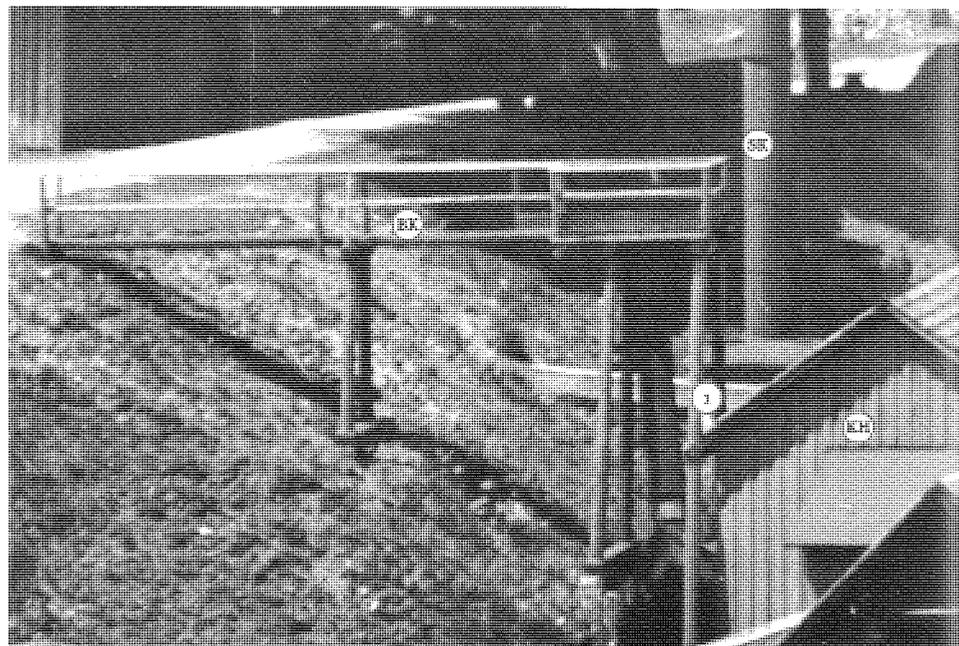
Holzbrücke am Kesselhaus mit Kohlenrutsche (aus Abb. 60).
